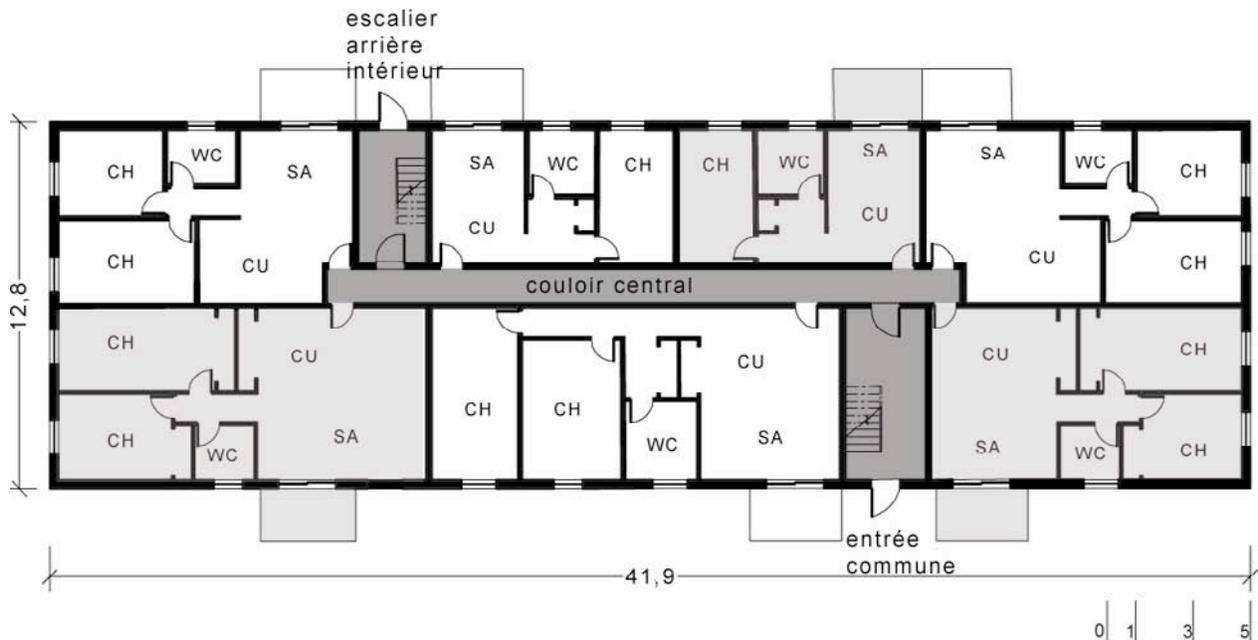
Plan schématique du rez-de-chaussée d'un walk-up de type 4
